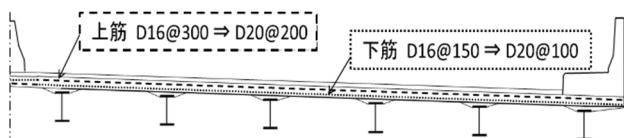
床版橋軸方向配筋図 (変更前⇒後)
